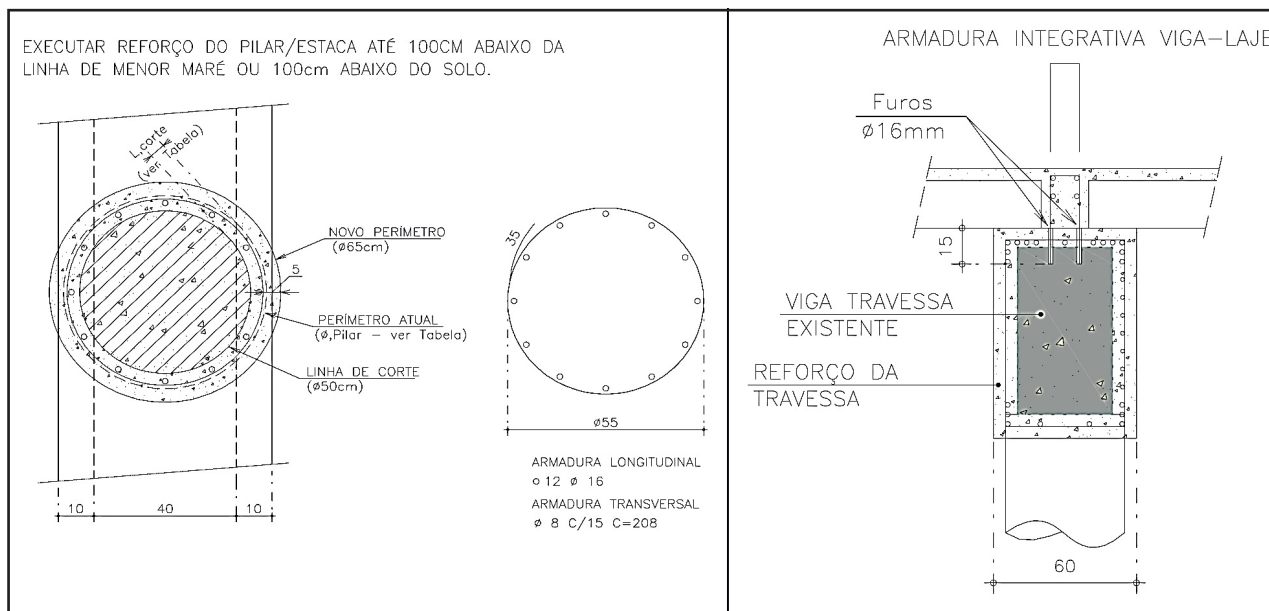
Detalhes do encamisamento e reforço de pilares e vigas travessas.
